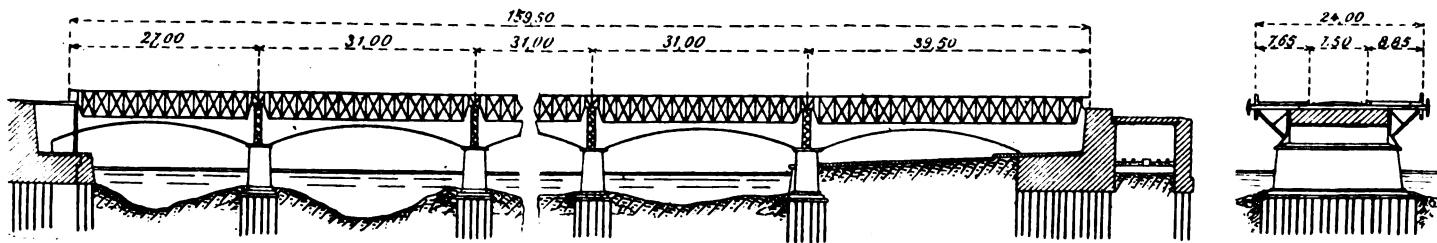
et 2. — Élévation et coupe transversale du pont d'Iéna élargi.
